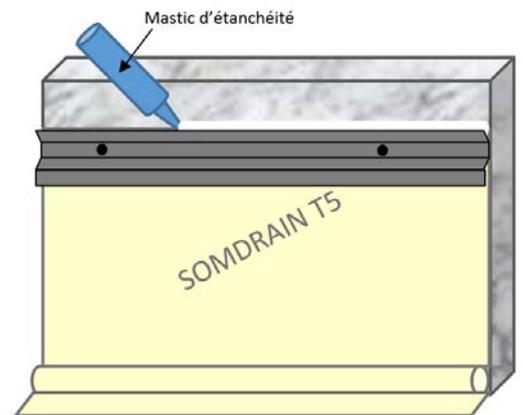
Mise en place du mastic d'étanchéité sur le solin
